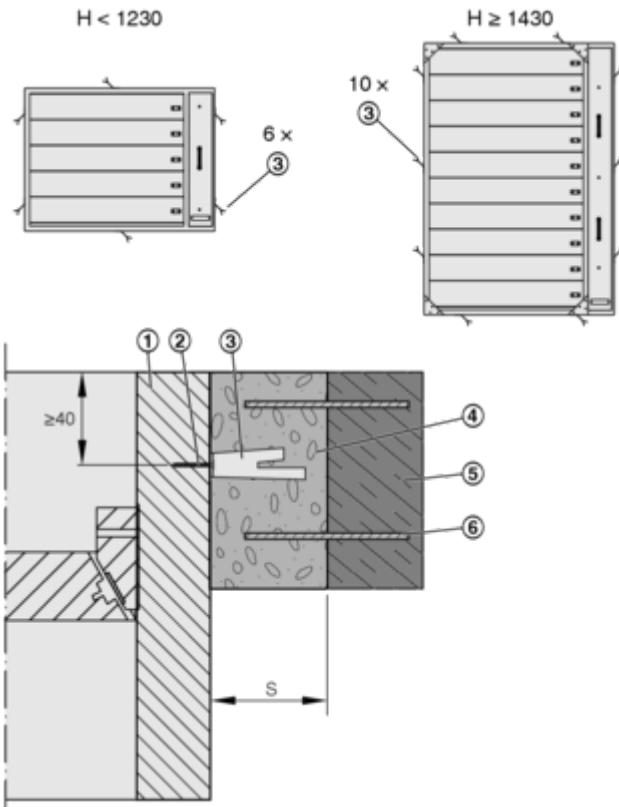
EK-JZ фиксиращо позициониране на пластините на стена
